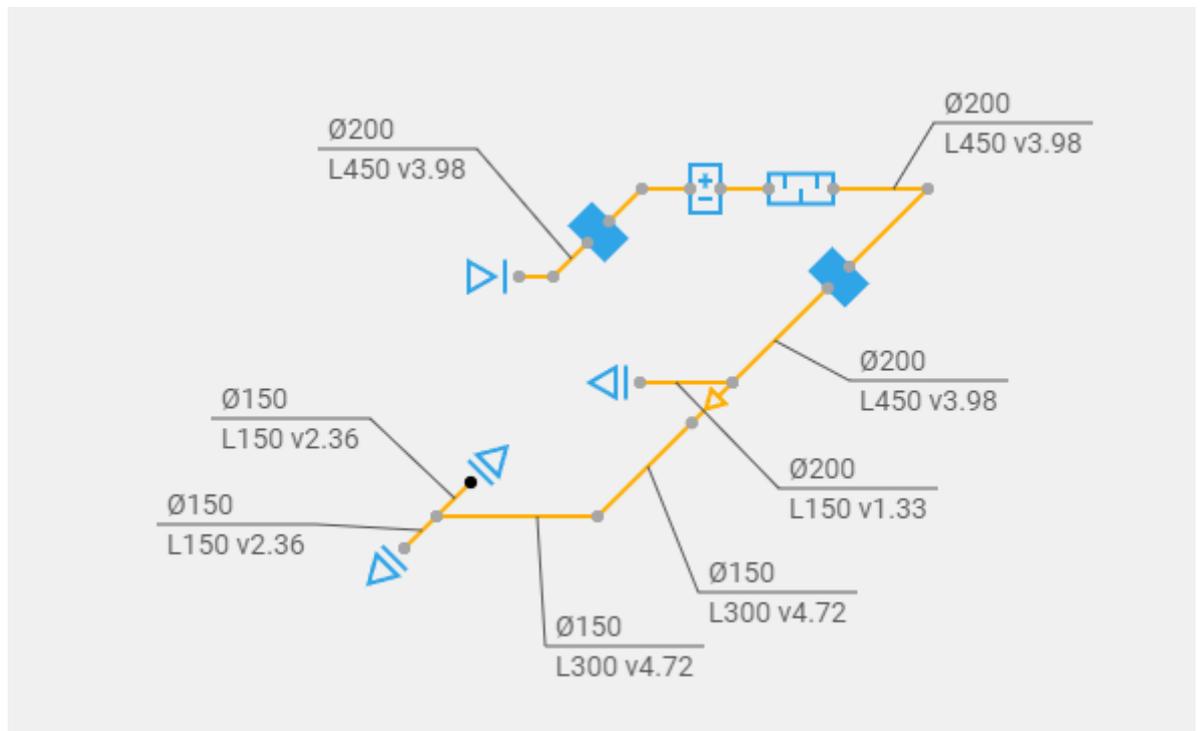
Фрагмент схеми вентиляції ПБ-14(приплив) для аеродинамічного розрахунку
